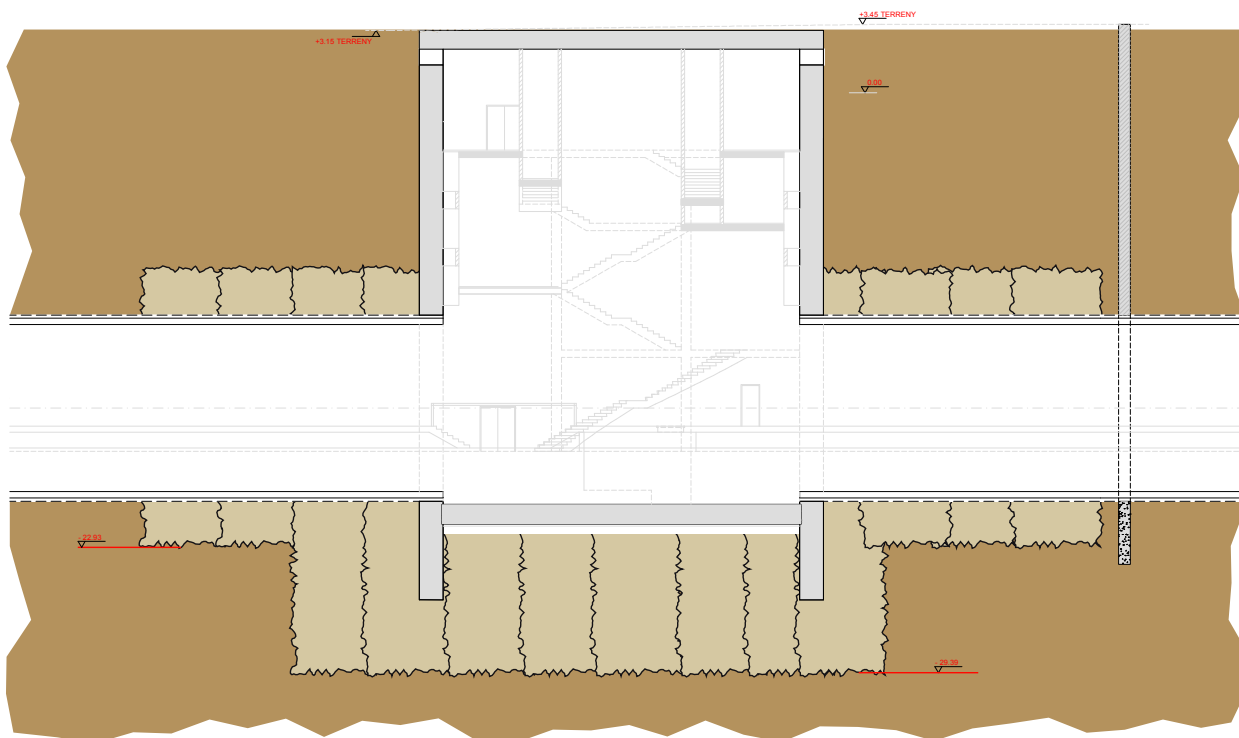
Sezione tipica di un pozzo con tampone di fondo centrale, break-in e break-out.
